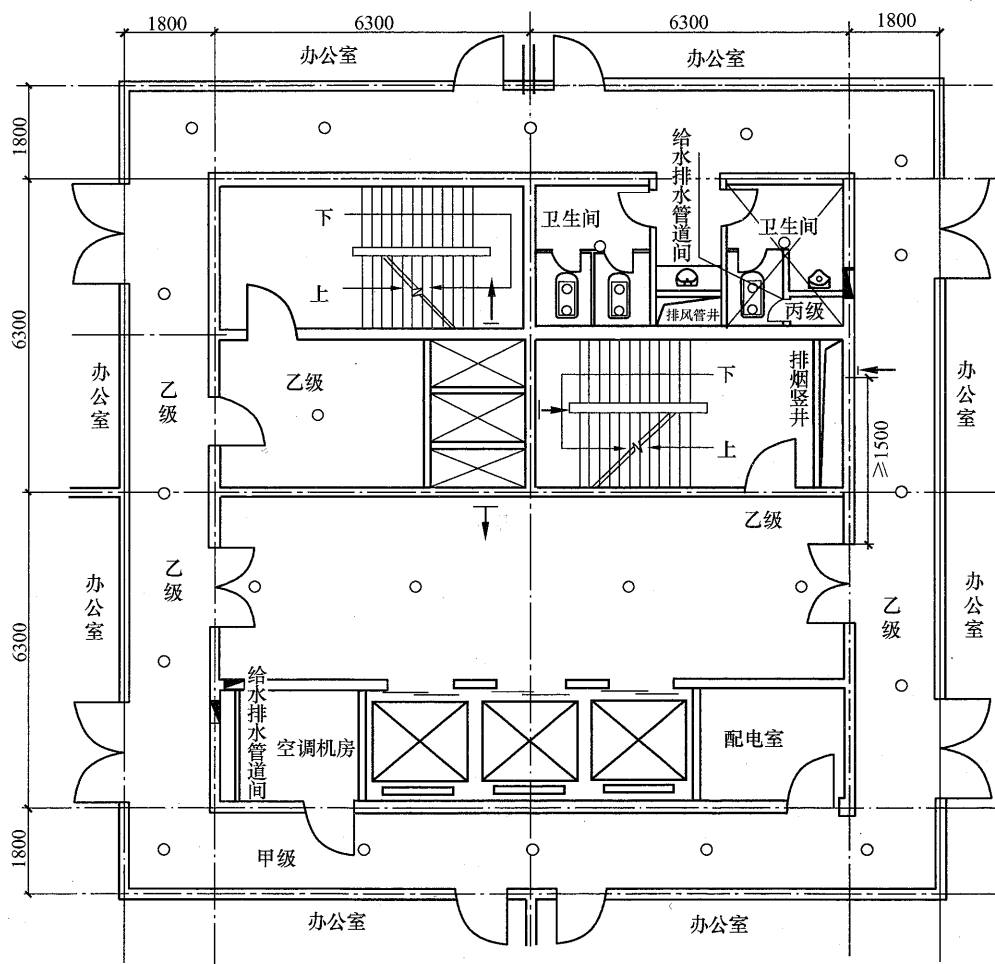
(a) 高层办公建筑五至二十二层局部设备平面图 (参考答案)
